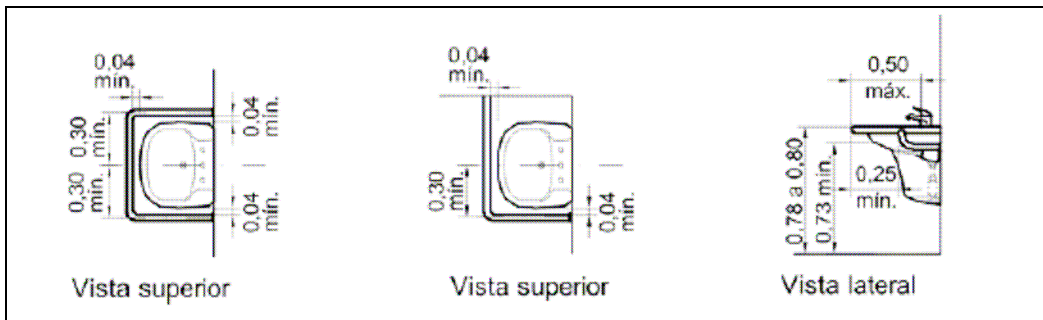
Instalação de barras de apoio junto ao lavatório (Figura 136 da NBR 9050).
